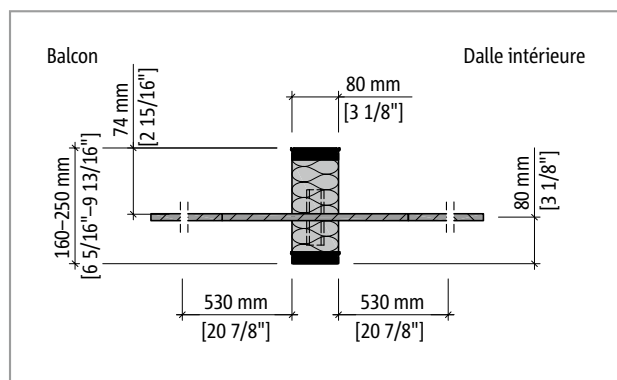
Schöck Isokorb® T Type CH-NN2 : coupe transversale du produit
